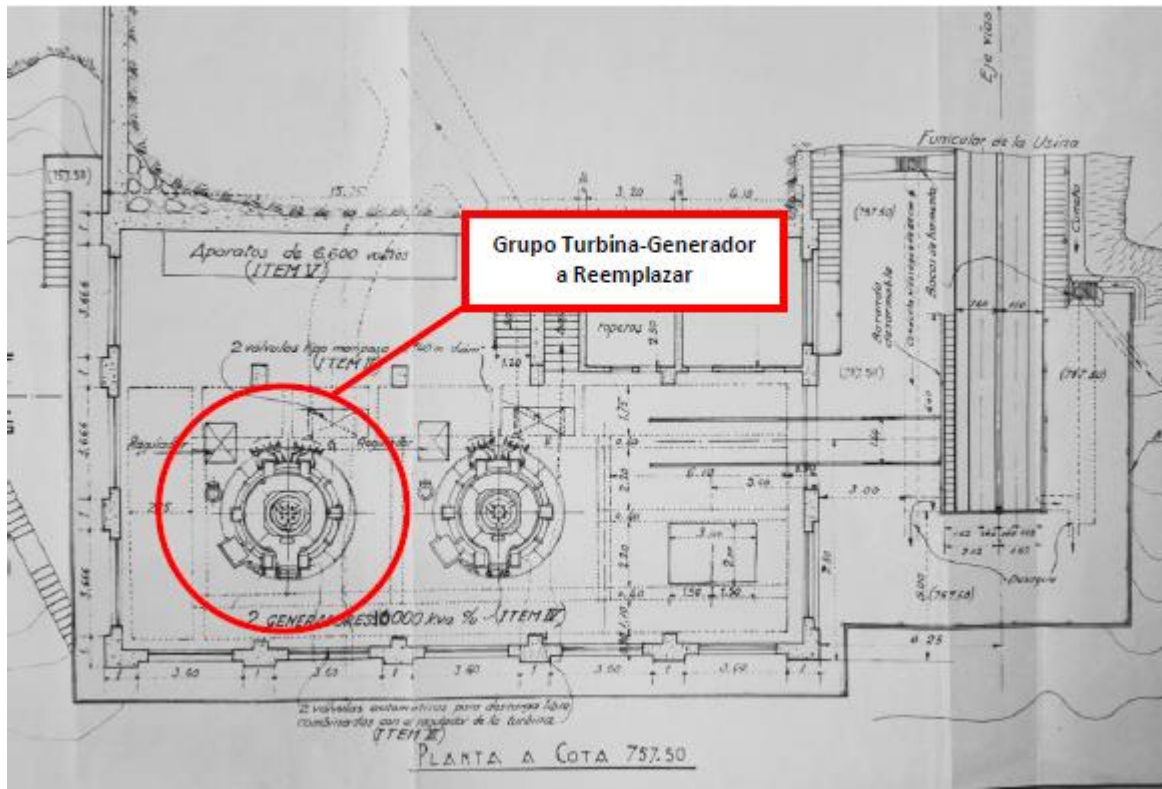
Plano en planta de la central La Viña (se indica el grupo turbina-generator N°2 a reemplazar por una potencia menor, de 6 MW)
